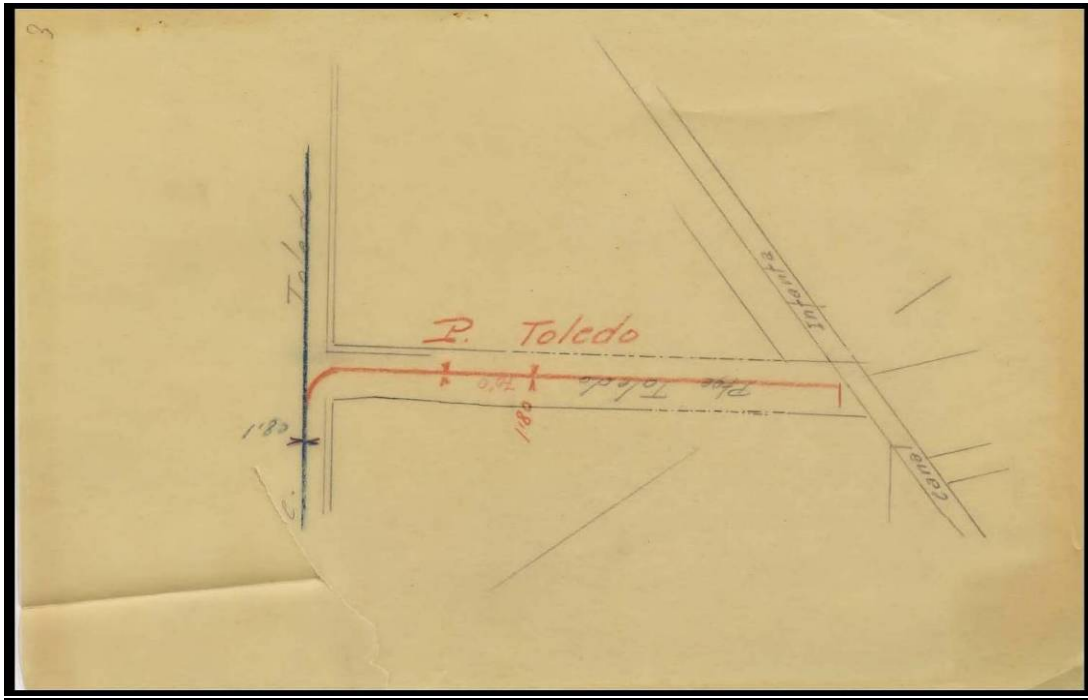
Estat final de l'obra constructiva al passatge de Toledo.
